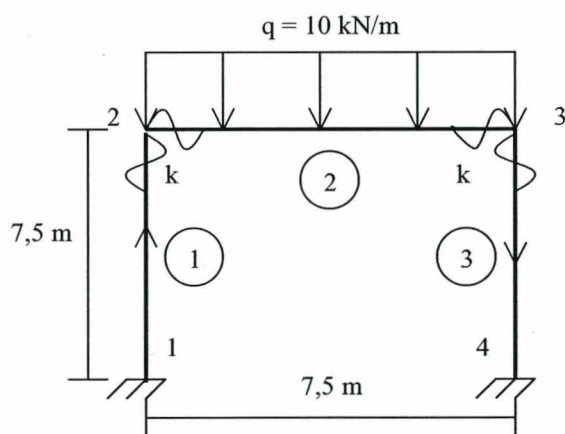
Pórtico plano com aplicação das “molas” na viga e pilar.
